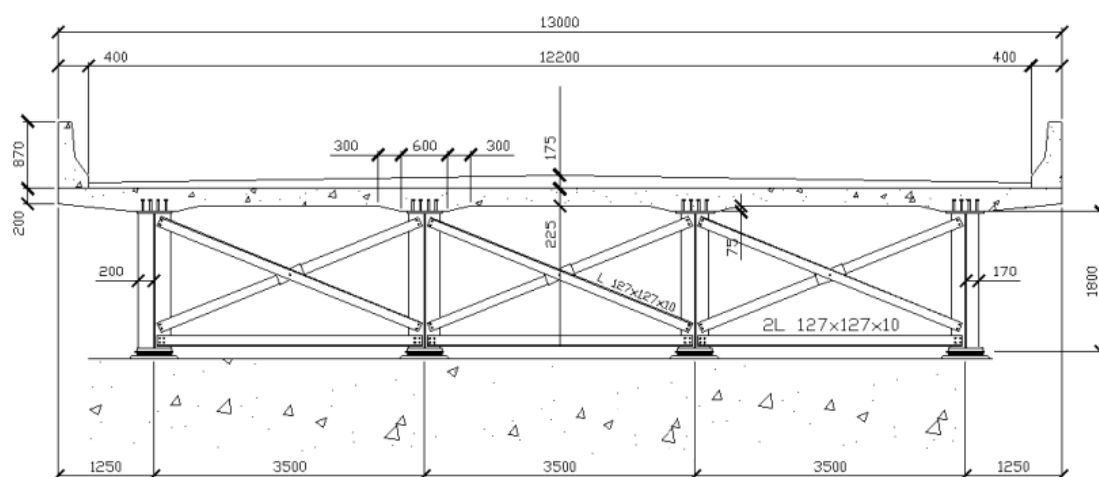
Seção transversal nos apoios da ponte da ponte em vigas mistas (adaptado de BELLEI e PINHO, 2007). Dimensões em mm.
